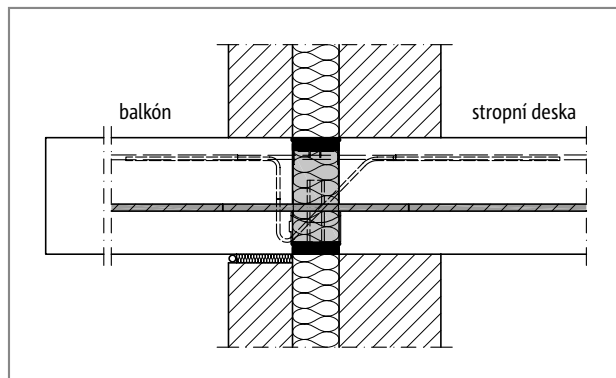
Schöck Isokorb® T typ HP: Volně vyložený balkón
